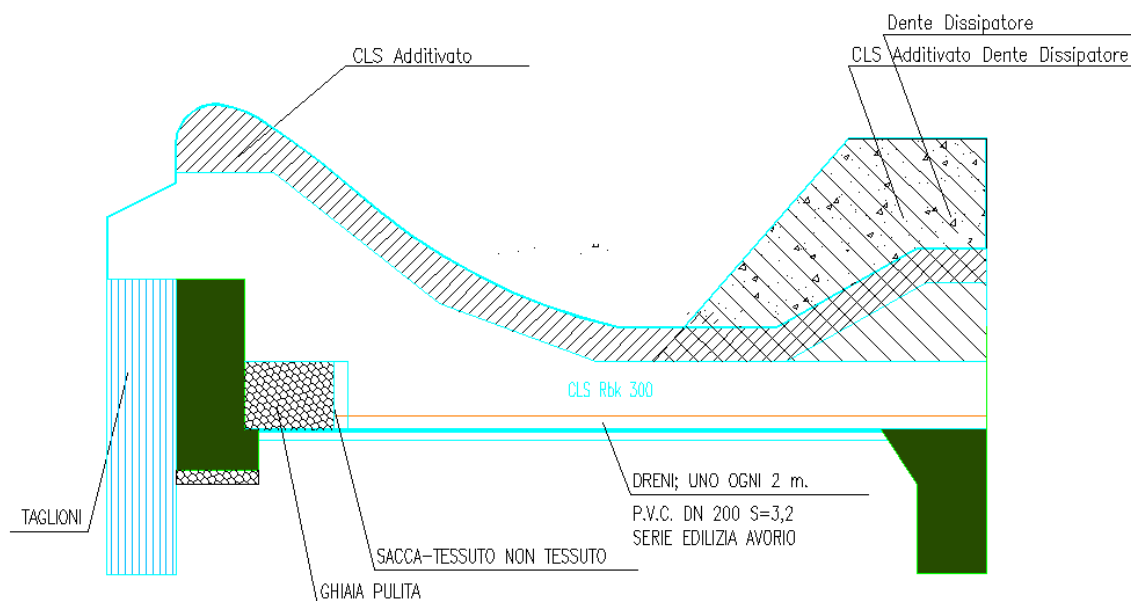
Traversa di monte - Sezione di progetto.
